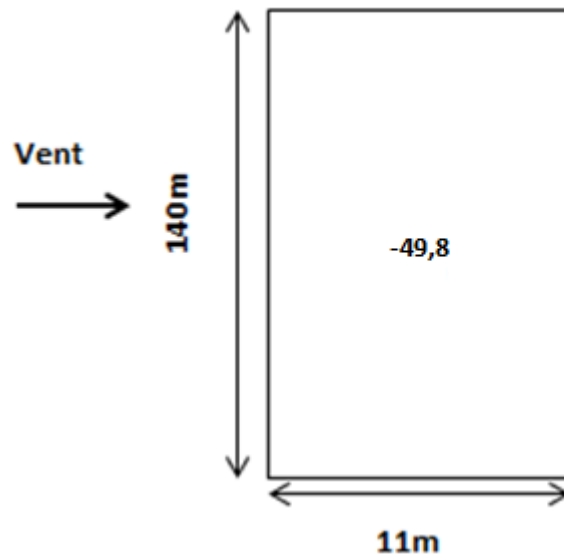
Pressions sur la toiture versant 4 directions du vent (V2,V4) [daN/m^2].
